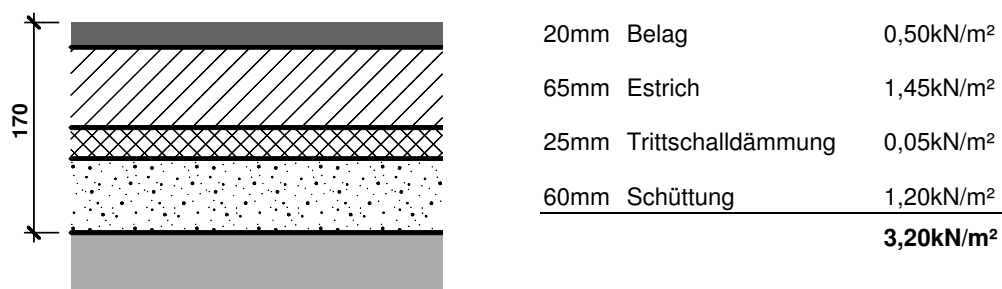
Definition Aufbau Massivholzdecke (inkl. zusätzlicher Schüttung)
